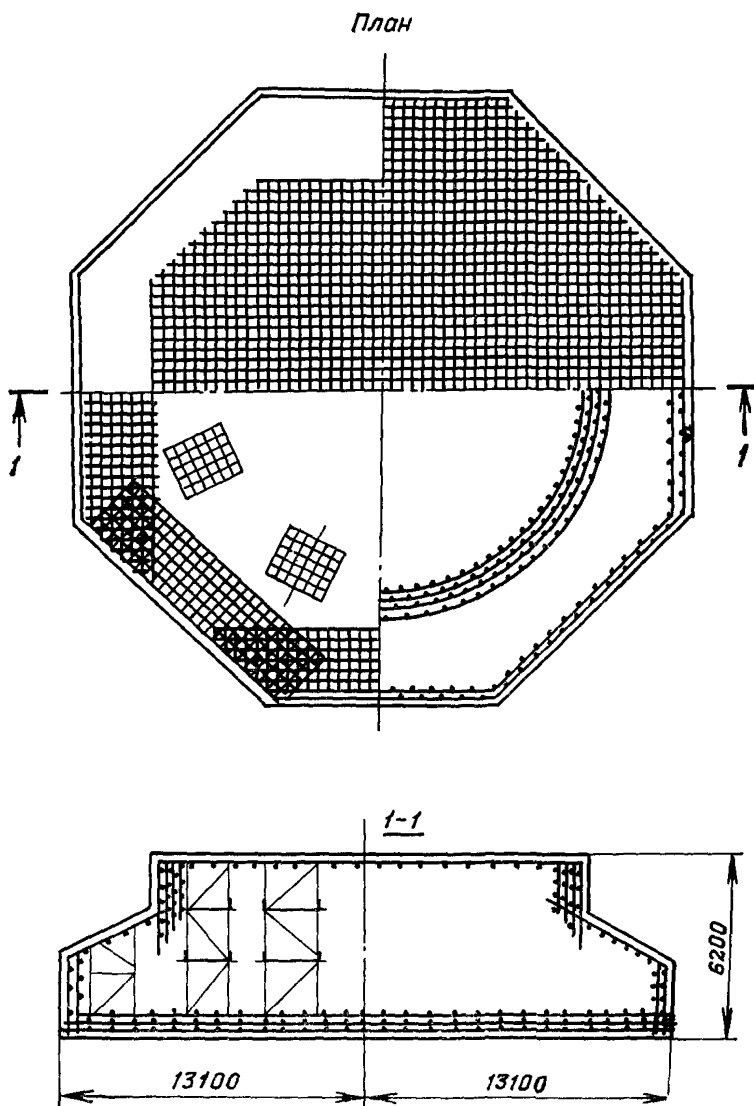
Характер армирования несущей плиты фундамента (не изображена дополнительная арматура по периметру подошвы плиты, воспринимающая тангенциальные усилия)
